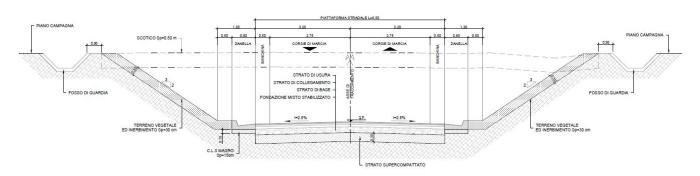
Dest. Particolare 6.5m - sezione tipo in trincea
